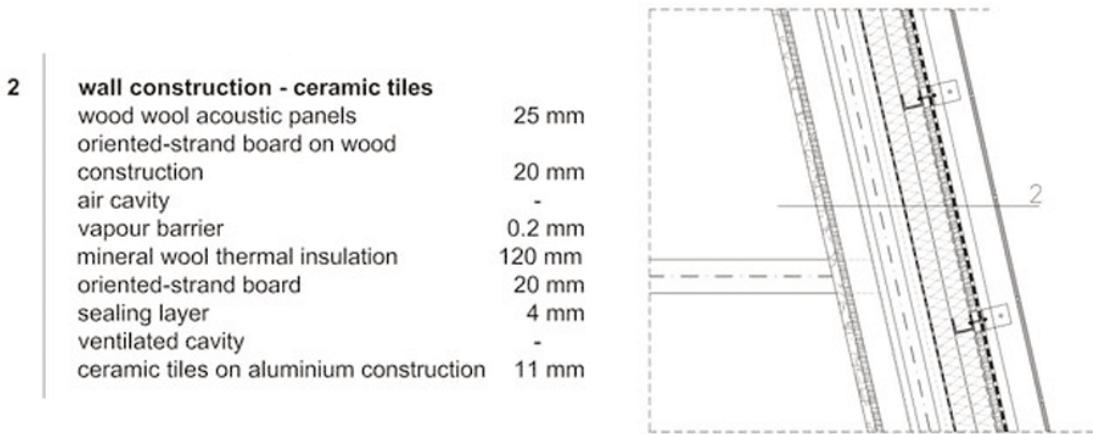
Detalhe construtivo da fachada tipo do Zamet Cultural Center (caso de estudo apresentado no Capítulo 3).
